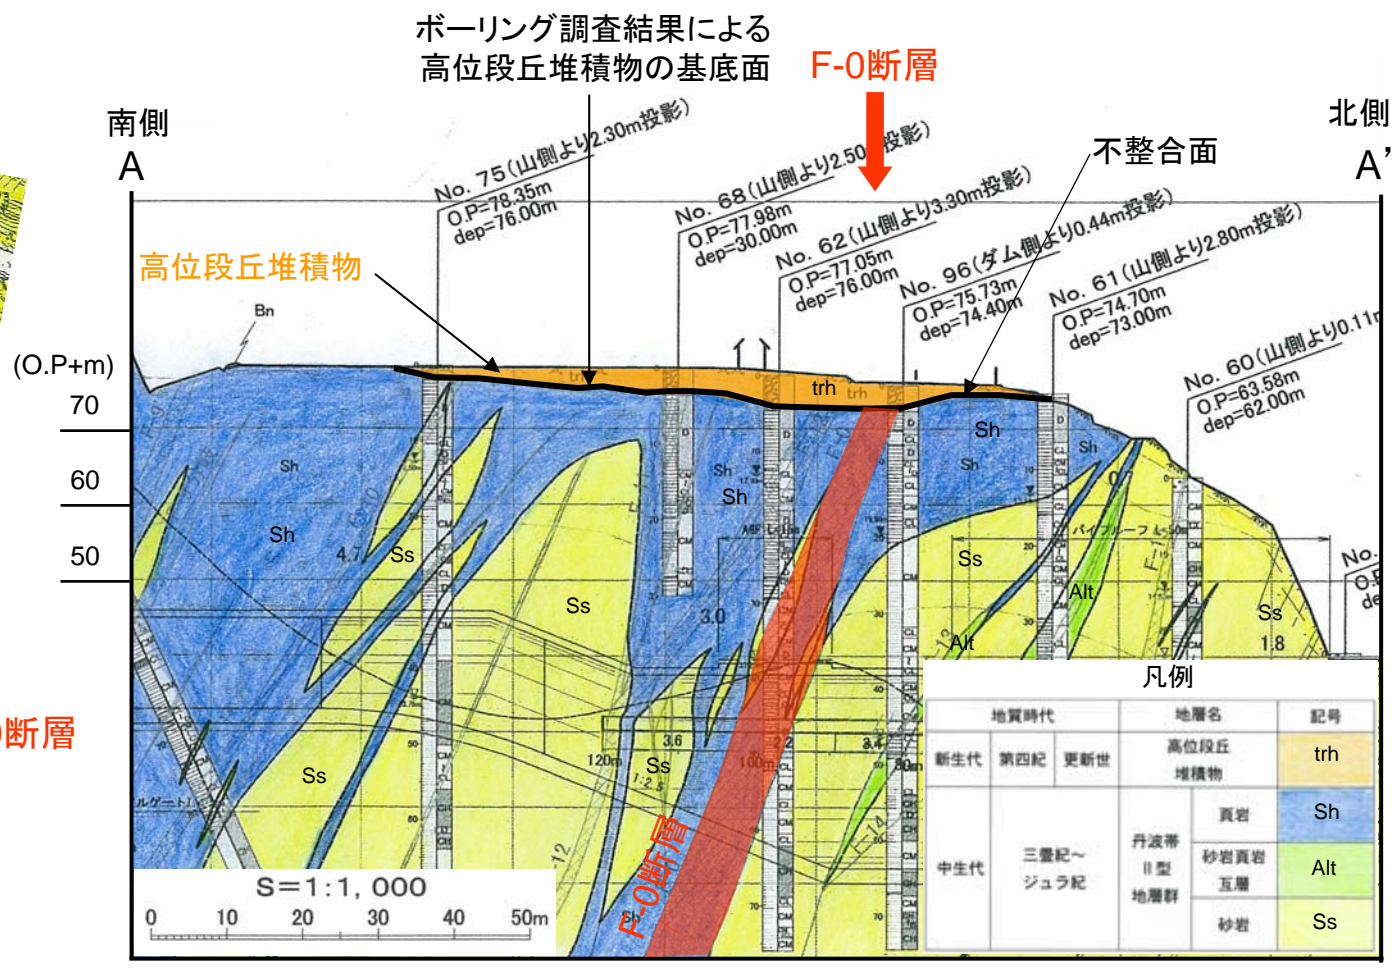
放水路トンネル地質断面図(A-A'断面)
